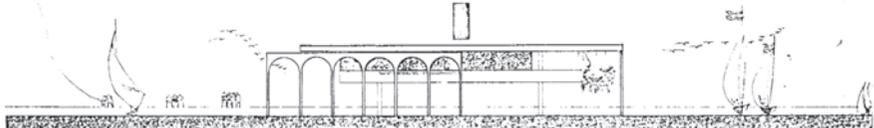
planta e cortes projeto executivo – planta, cortes e elevações portinho.
